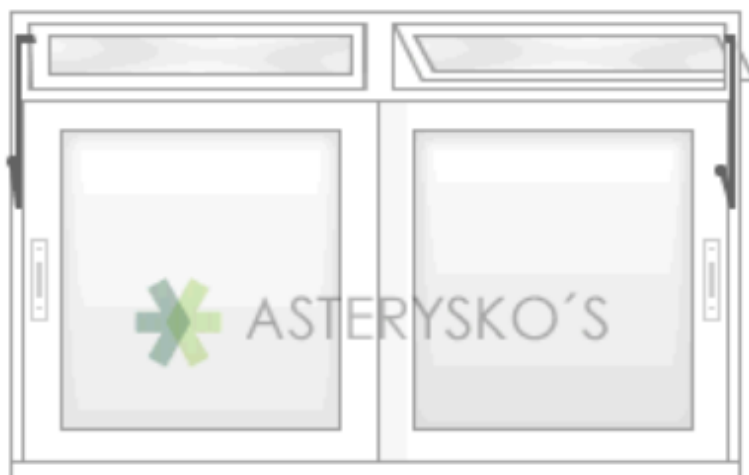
Janelas originais nas fachadas principais do Lord Palace Hotel.
